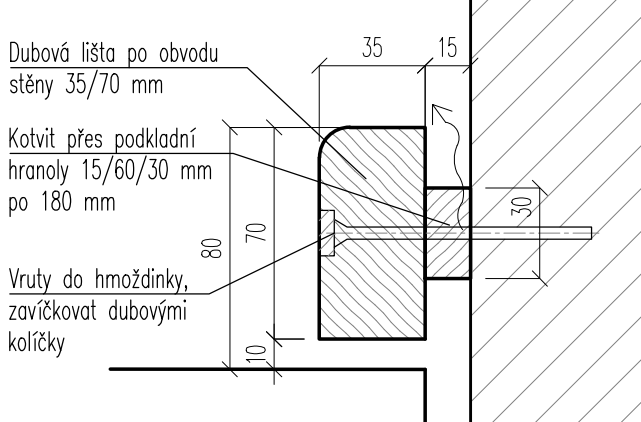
DETAIL ODVĚTRÁVANÉ PODLAHY SCHODIŠTĚ
